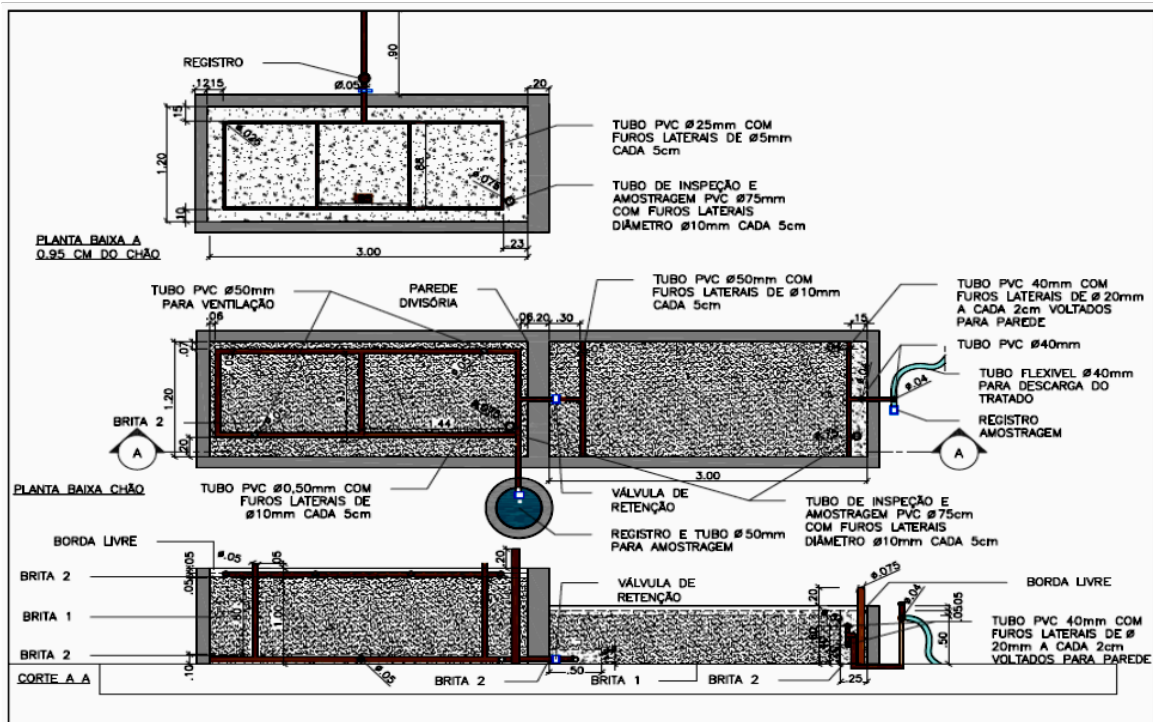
Desenho esquemático da WC Híbrida (plantas e corte)
